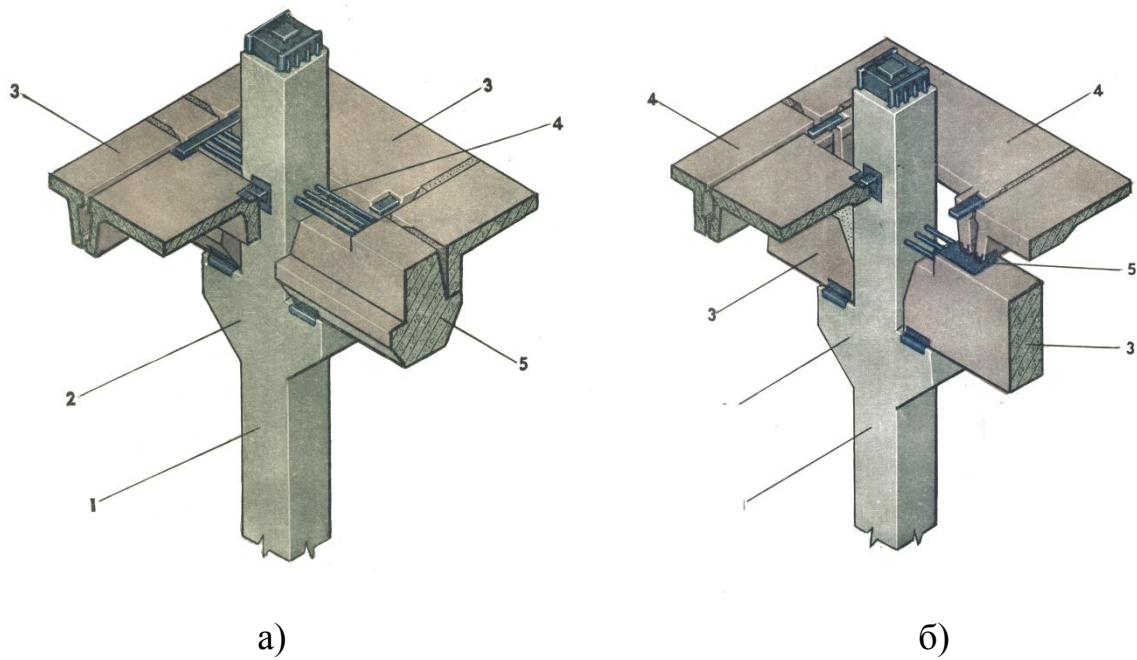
З'єднання залізобетонних колон з конструкціями перекриття: 1 - колона, 2 - консоль колони, 3(а) - плита перекриття, 3(б) - ригель прямокутного перетину, 4(а) - випуск арматури ригеля, 4(б) - плита перекриття, 5(а) - ригель з опорними полками, 5(б) - закладні елементи
